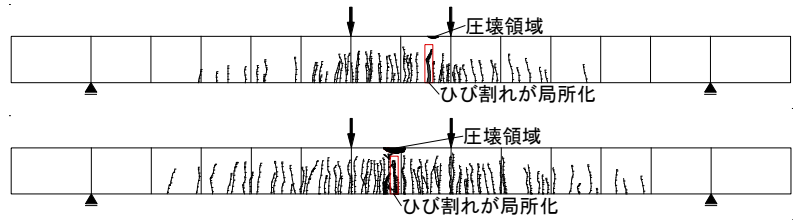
ひび割れ性状（上：プリント，下：型枠打込み）
